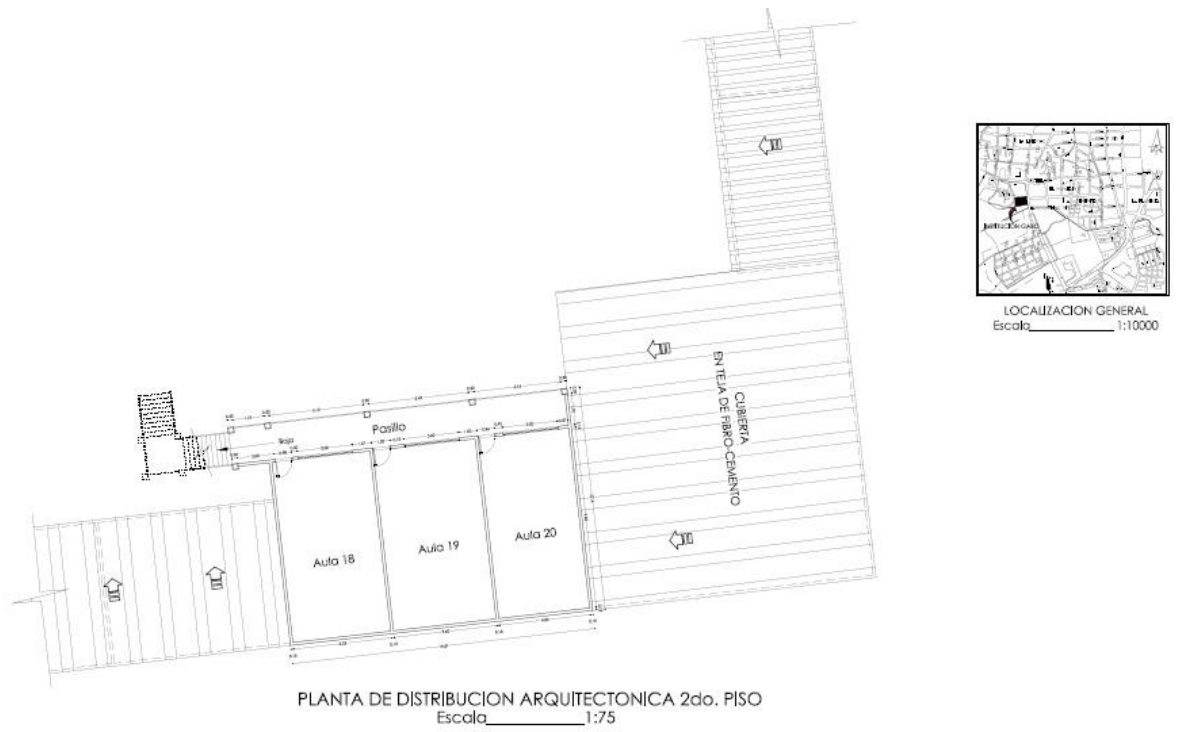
Plano arquitectónico. Planta 2º piso, 2005.
